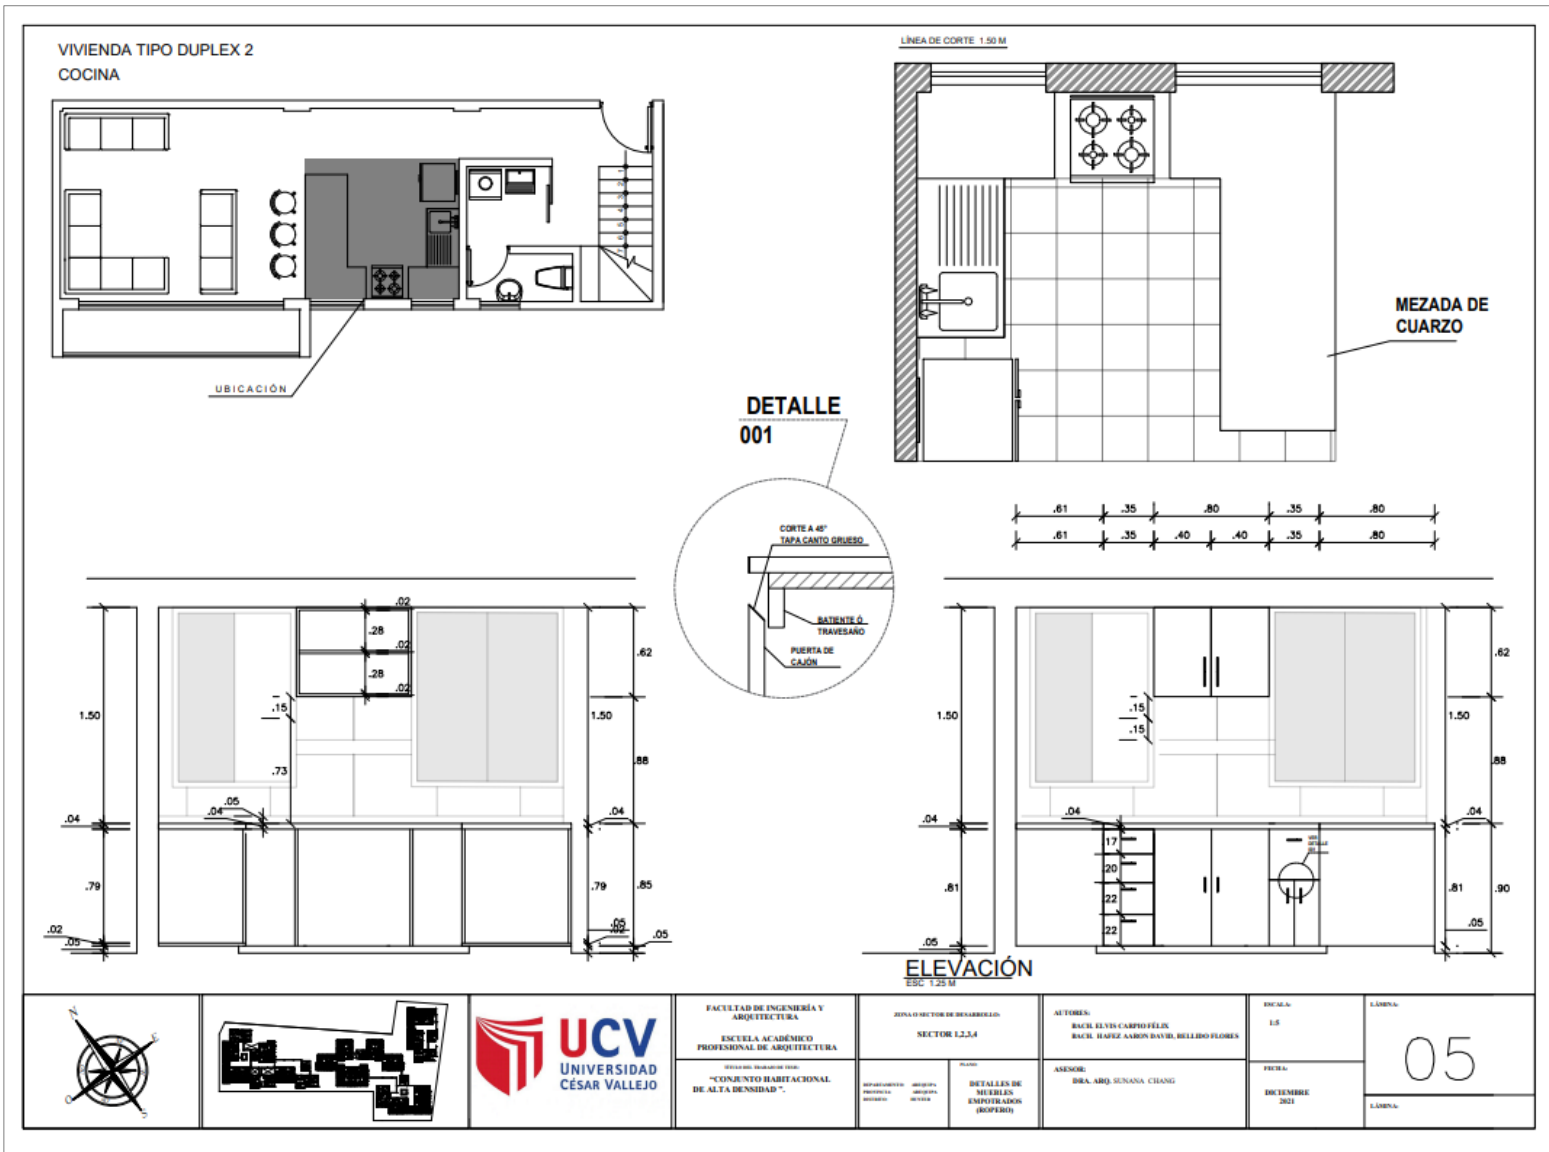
Plano de Detalle Arquitectónico – Cocinas Vivienda Tipo Dúplex 02 - 05
